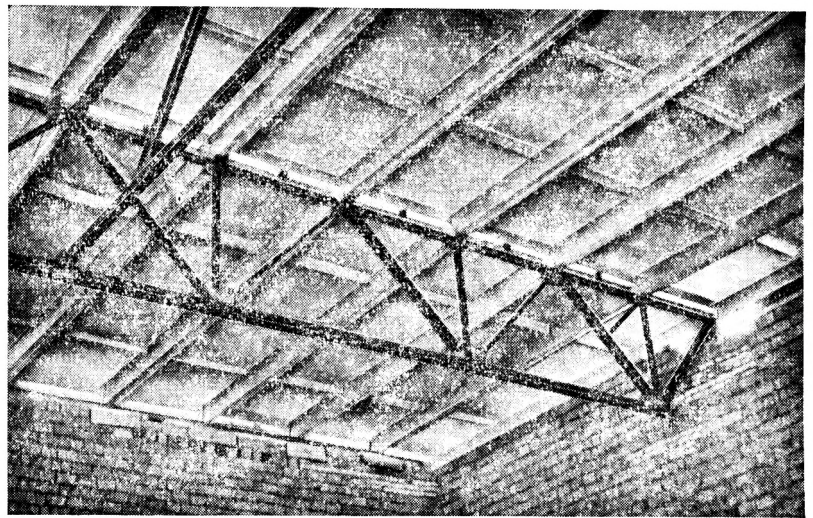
Вид перекрытия после приварки железобетонных кровельных плит.
